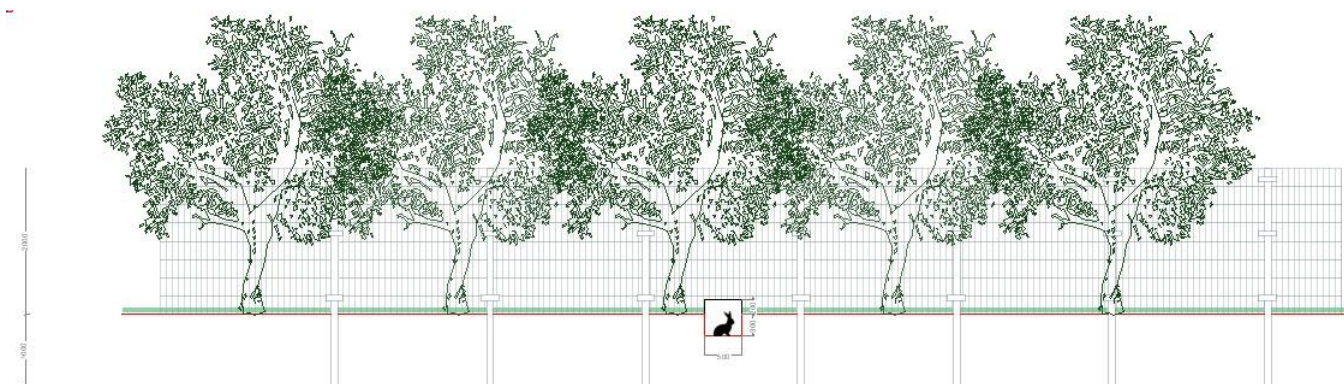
Tipico fascia perimetrale a verde e passaggi faunistici
